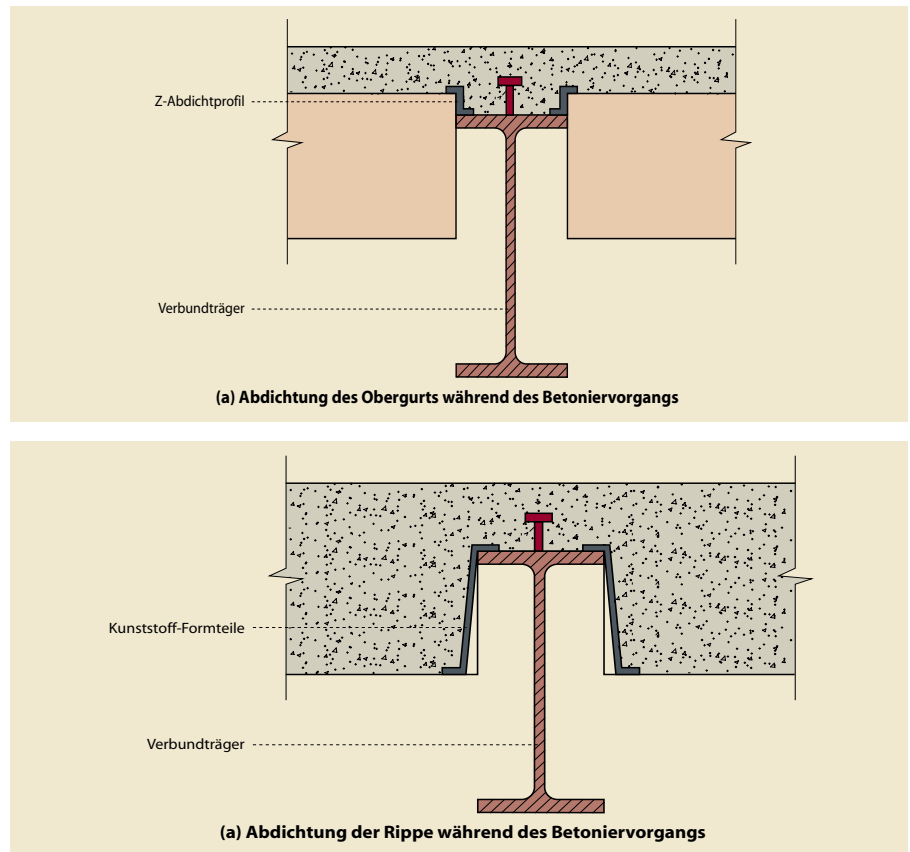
Ausgewählte Details der Hoesch Additiv Decke®
